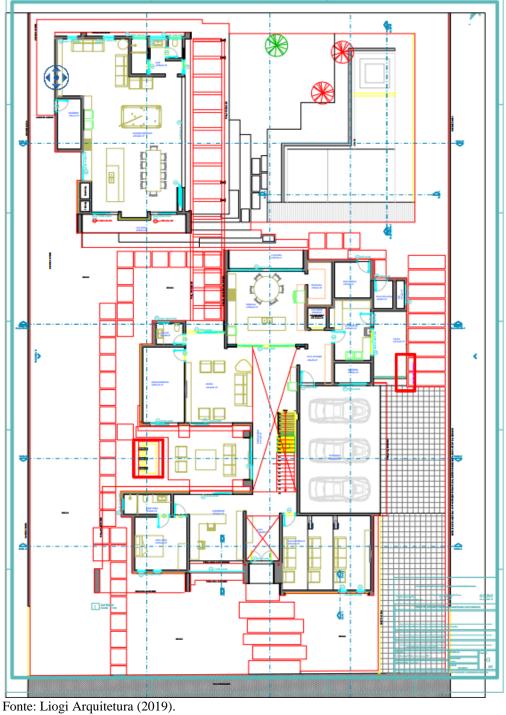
Planta baixa da edificação principal do pavimento térreo.
